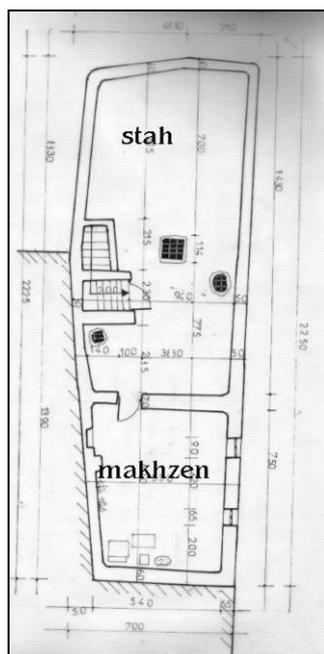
Une maison traditionnelle zibanaise, plan de l'étage
